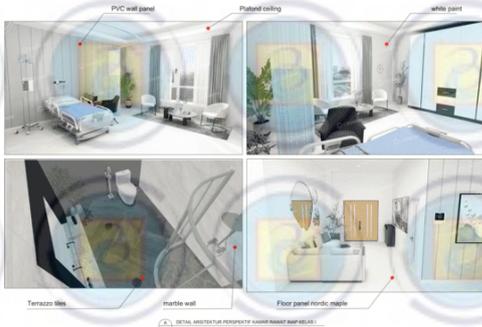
28. Denah Detail Arsitektur Kamar Rawat Inap Kelas VIP
